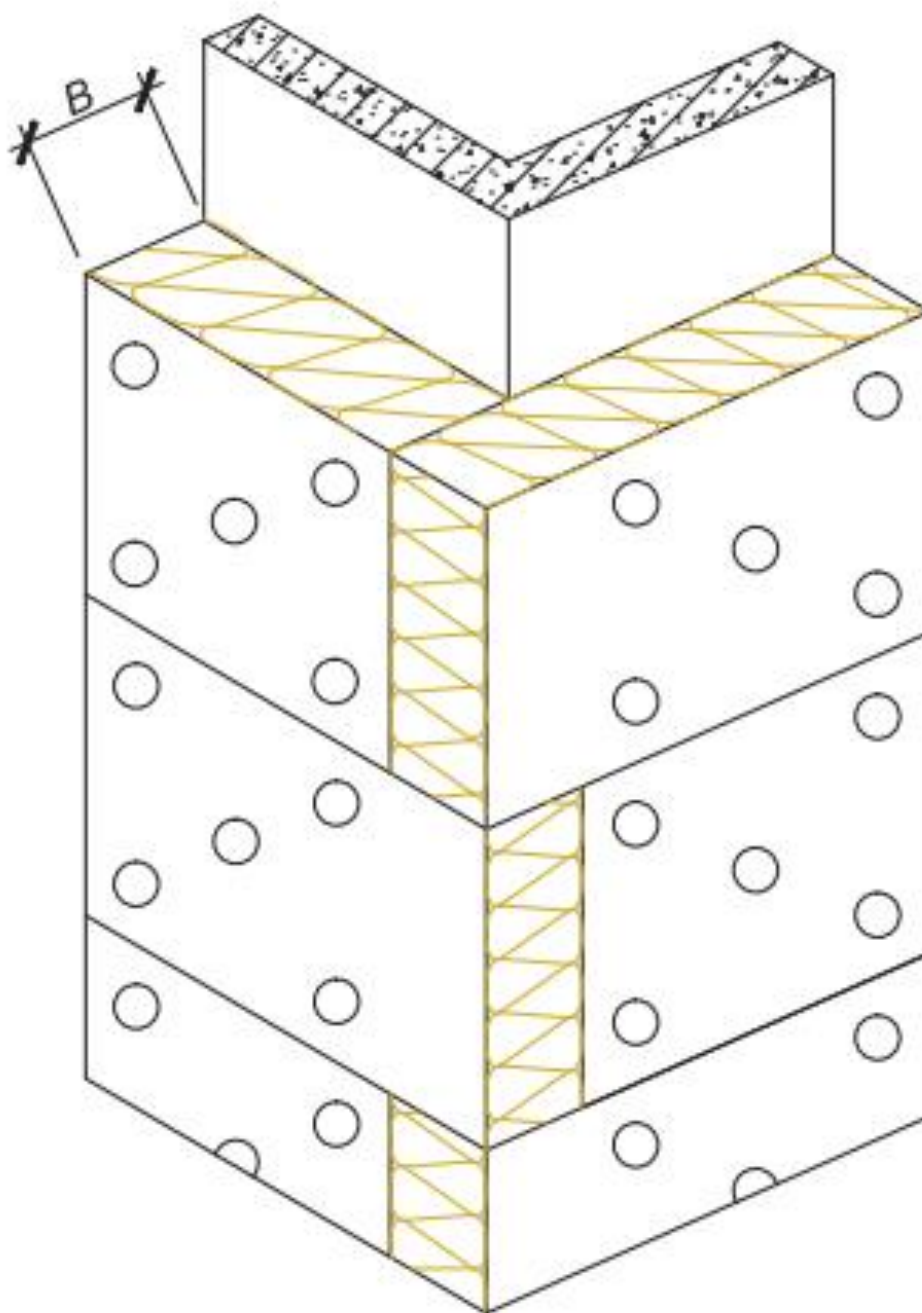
Схема кріплення утеплювача на кут будівлі
